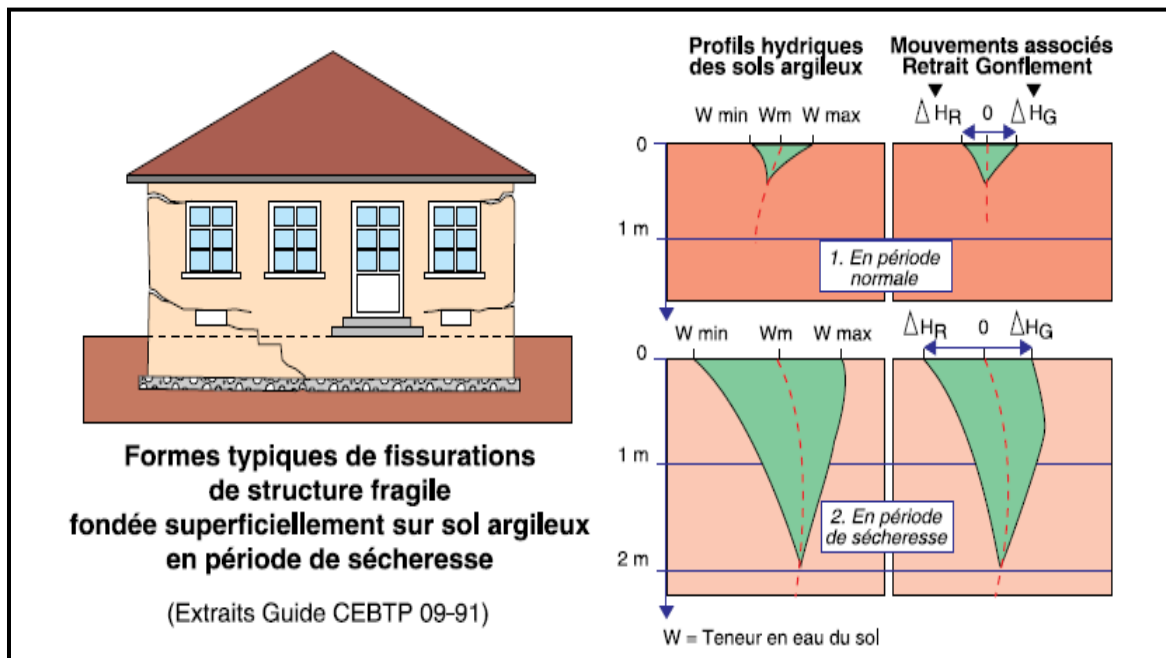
forme de fissuration de structure fragile fondée sur un sol argileux
